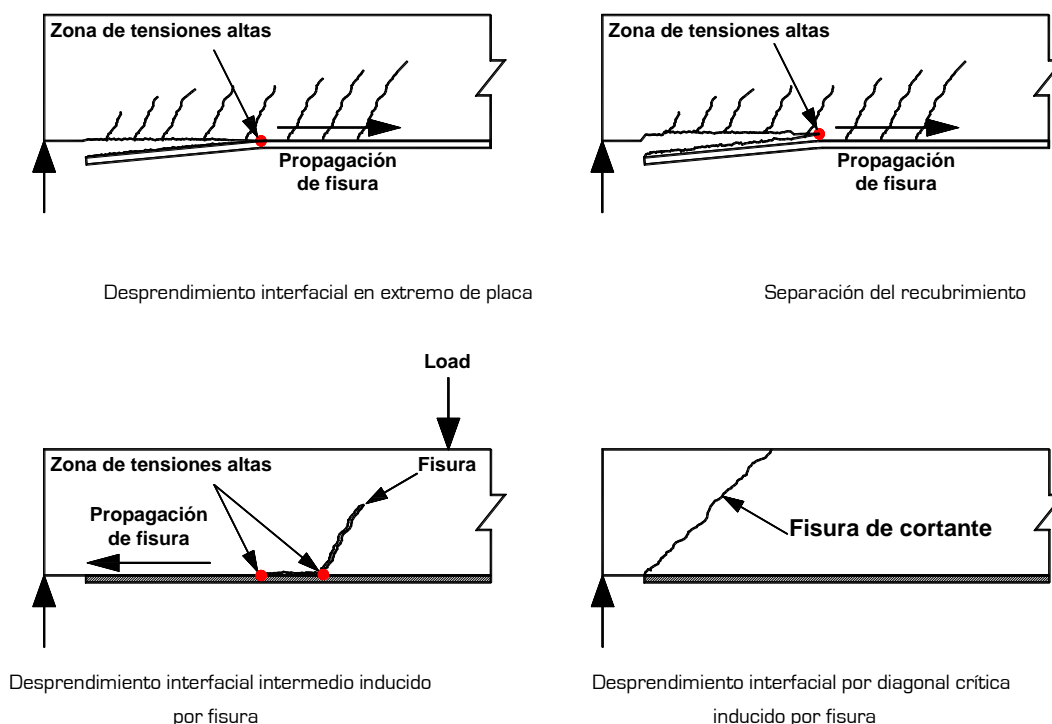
Modos de falla en vigas de hormigón armado EB FRP [adaptado de Saxena y otros 2008]
